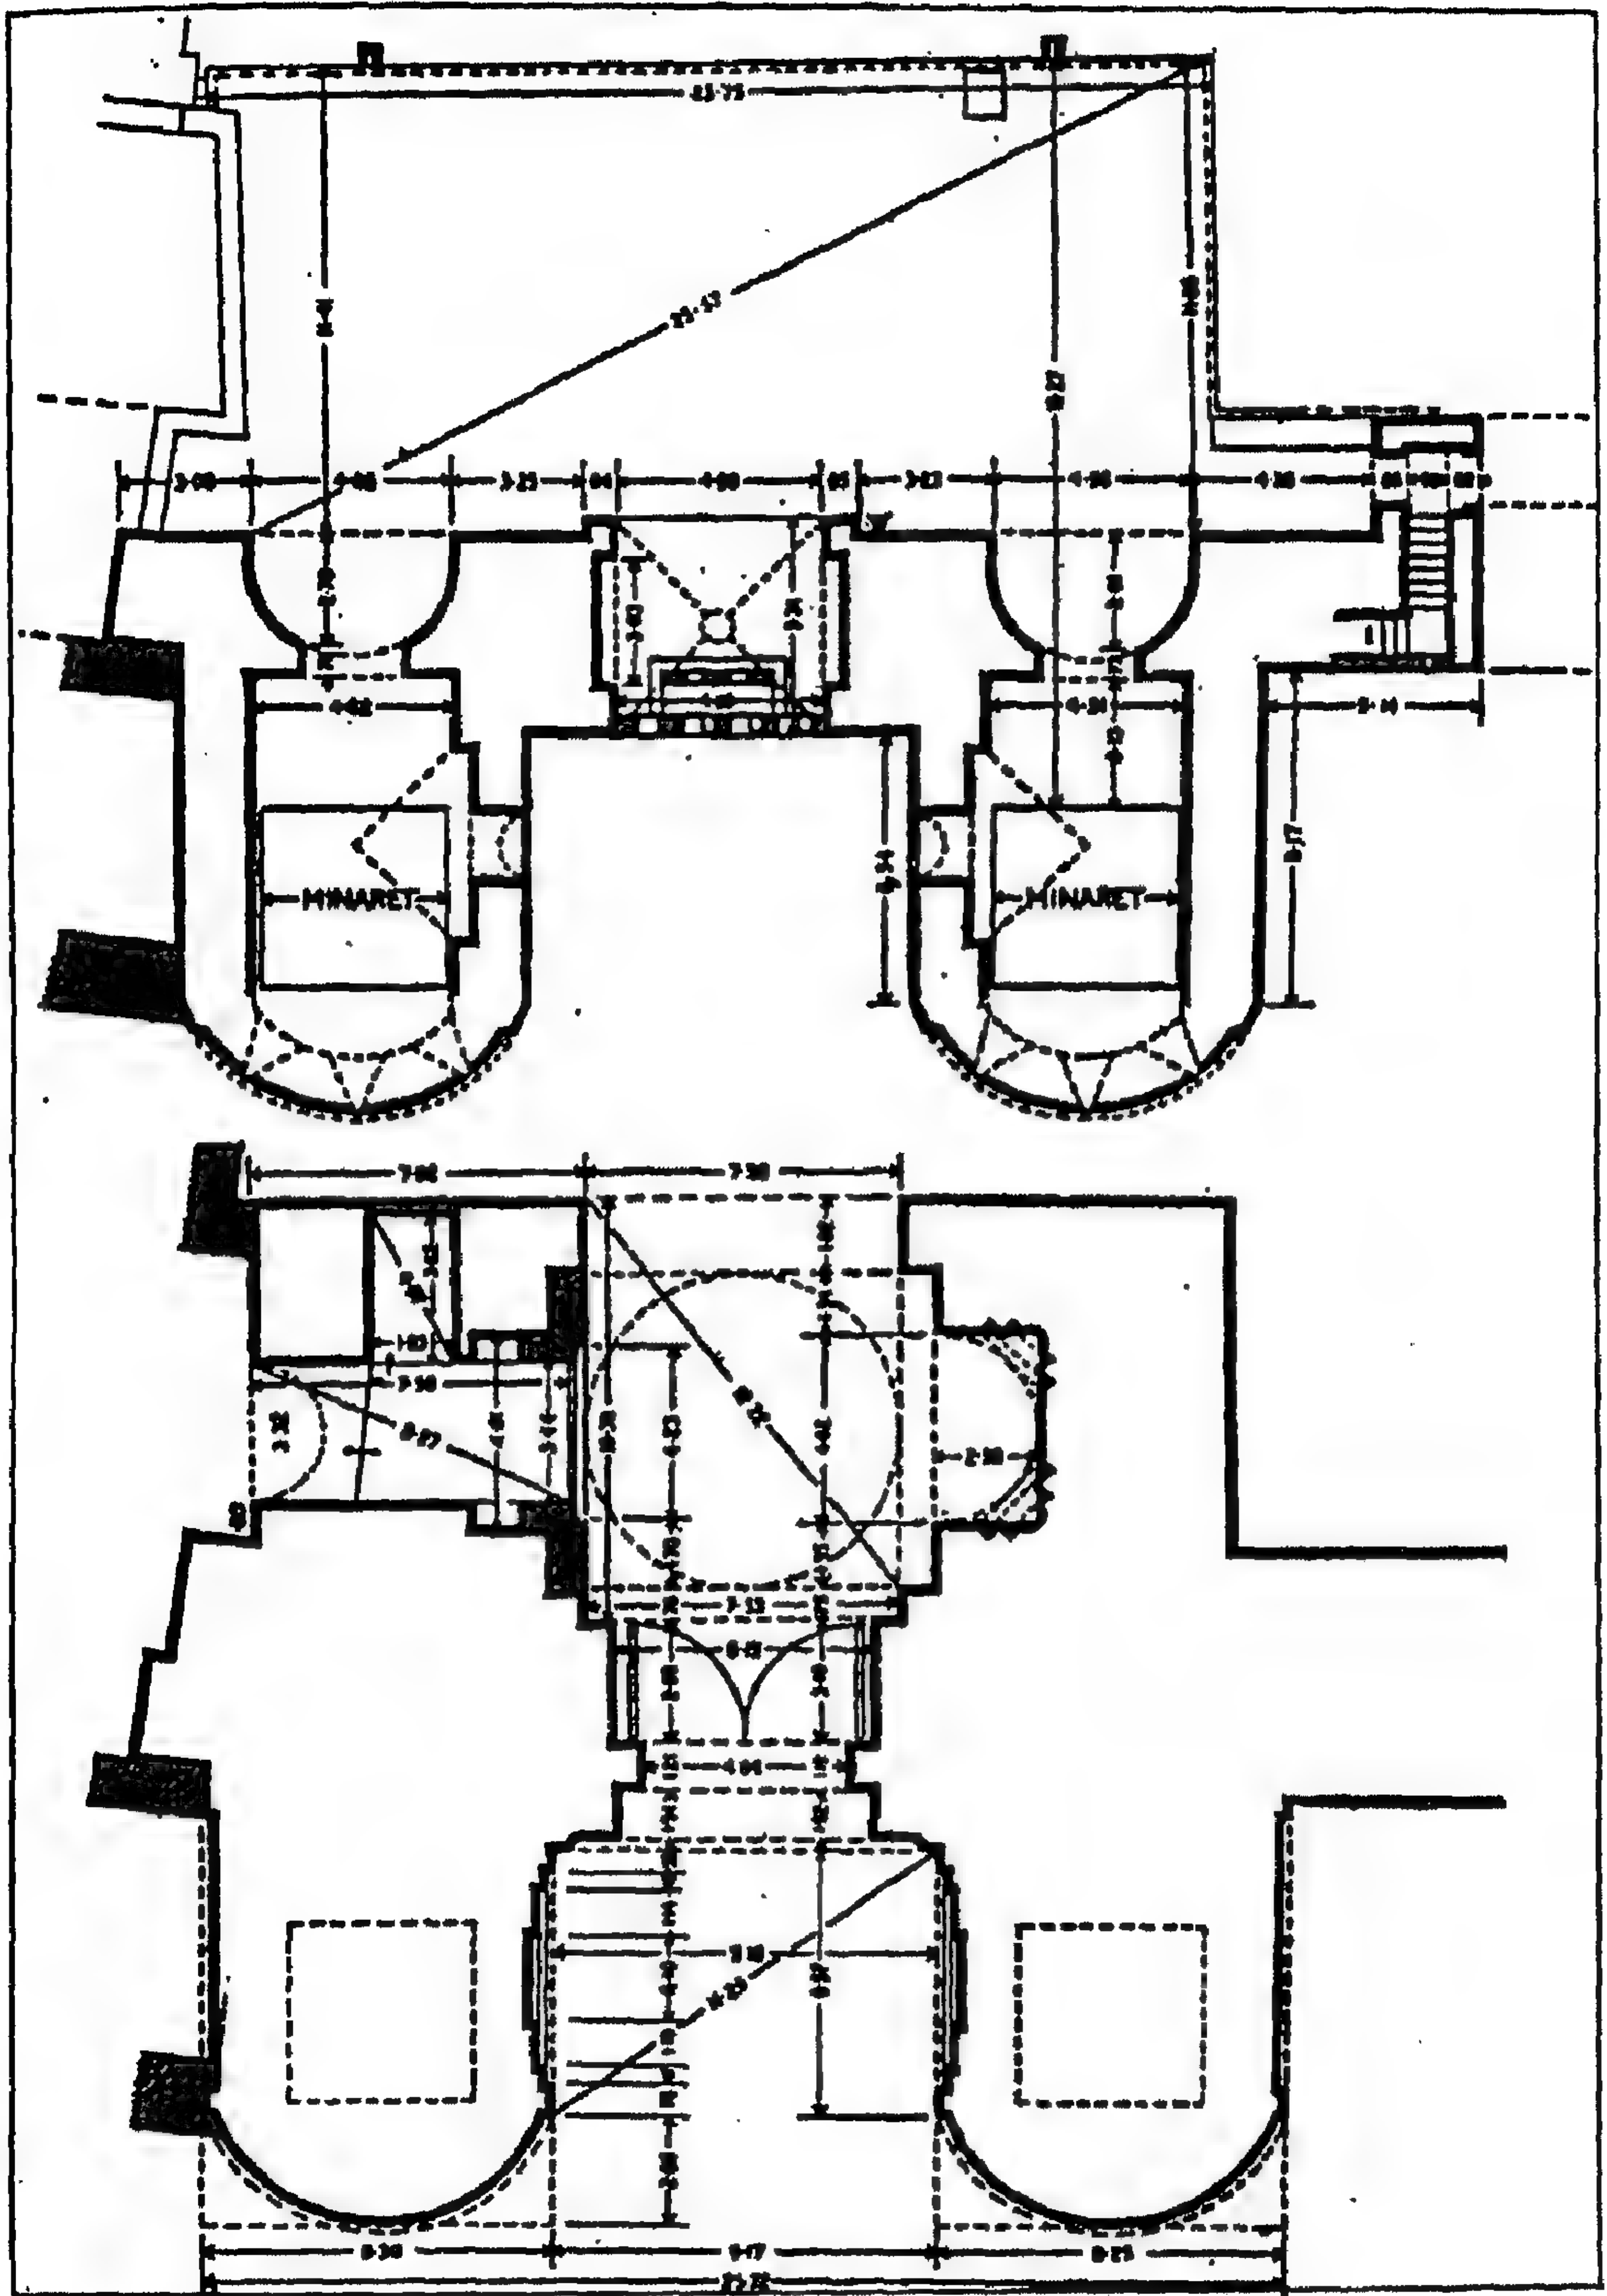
باب الفتوح، مسقط أفقي عن كرسويل
